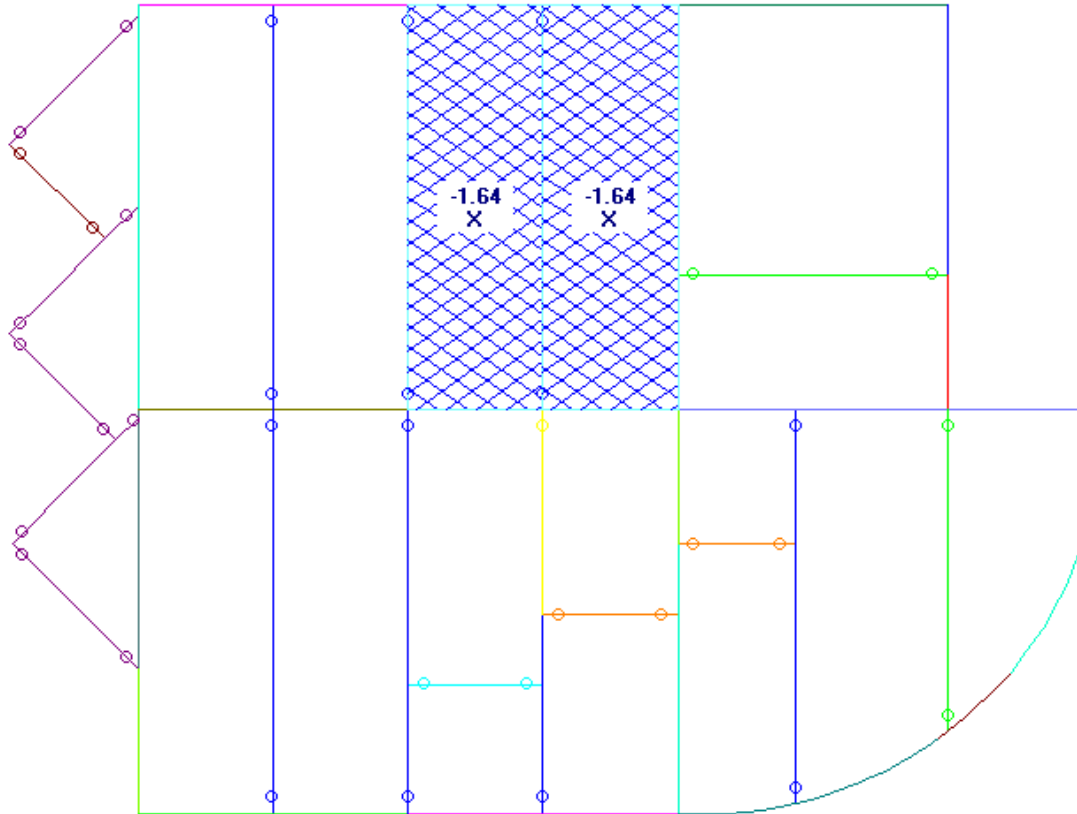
Casa de exaustão – Carregamento aplicado
